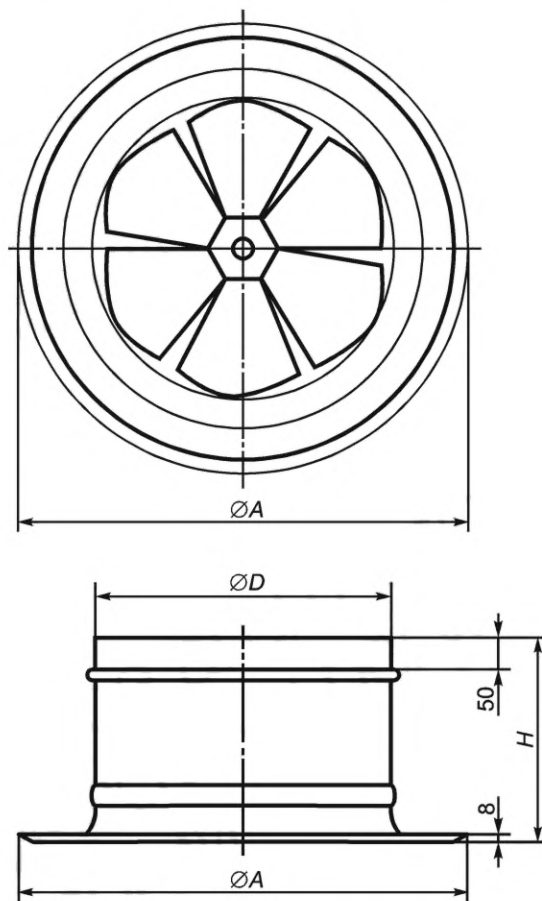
Пример конструктивной схемы диффузора с поворотными лопатками
